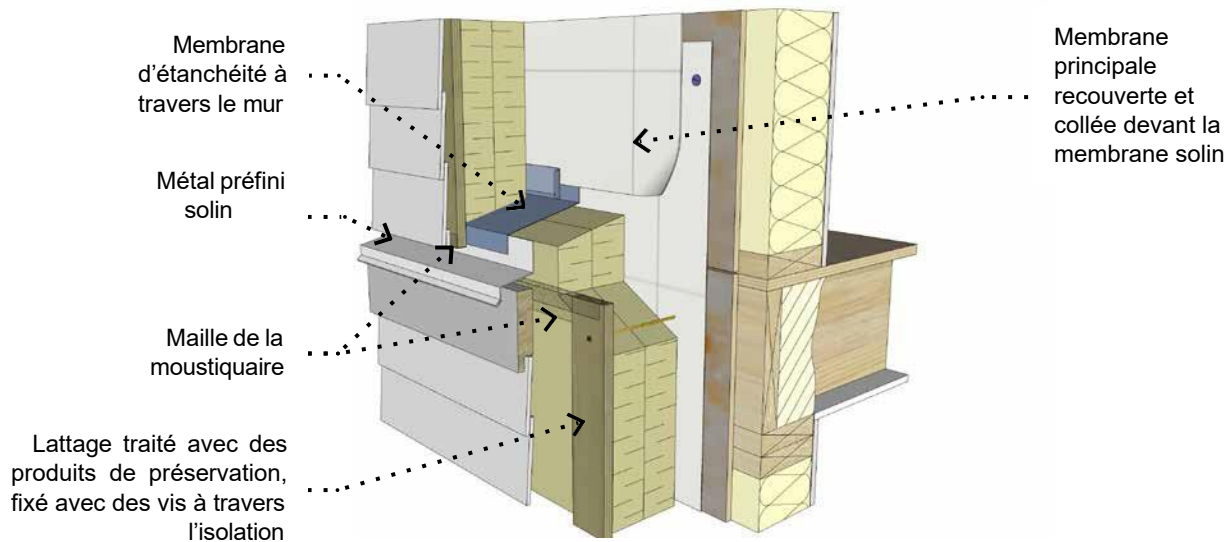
Détail du solin de traversée de mur conventionnel et installation du lattage
